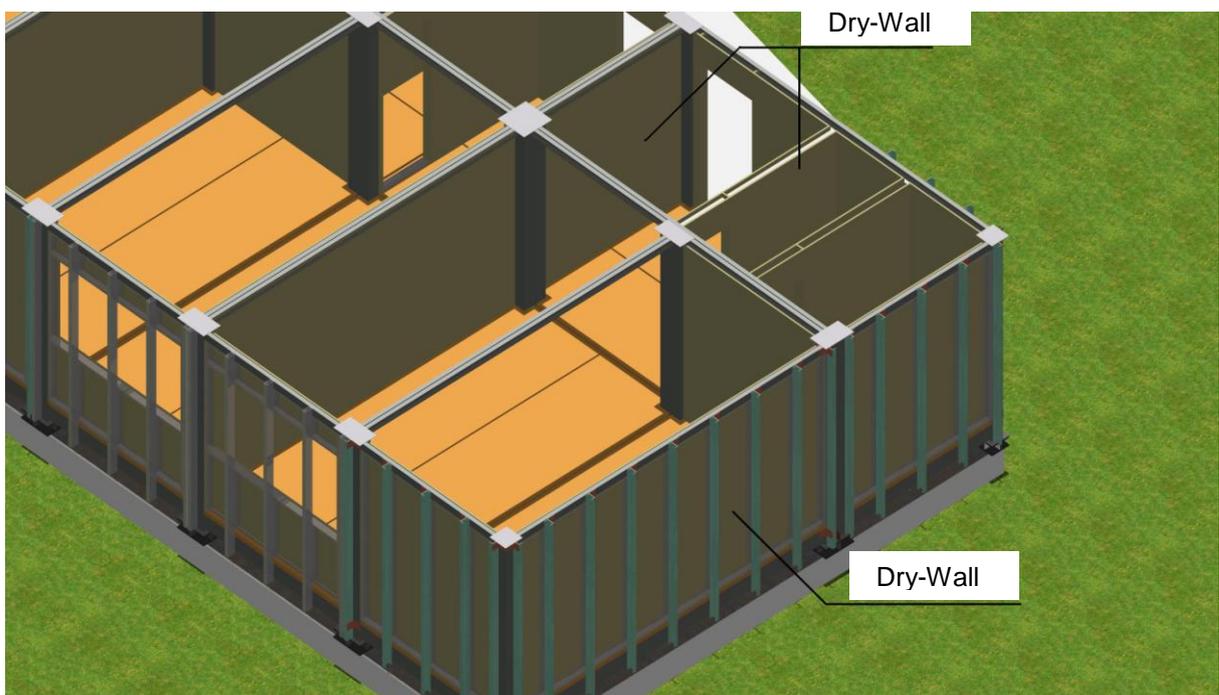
Vista da disposição do Dry-Wall na sala tipo.
